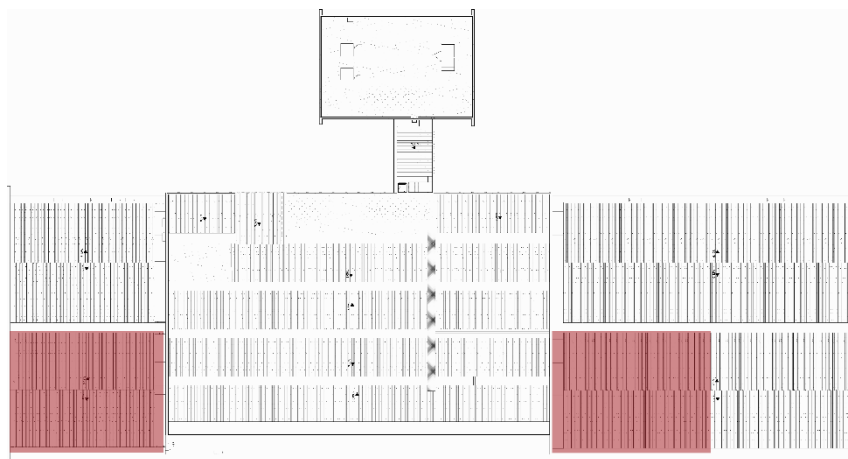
Área de intervenção na cobertura (nível 11º pavimento)
